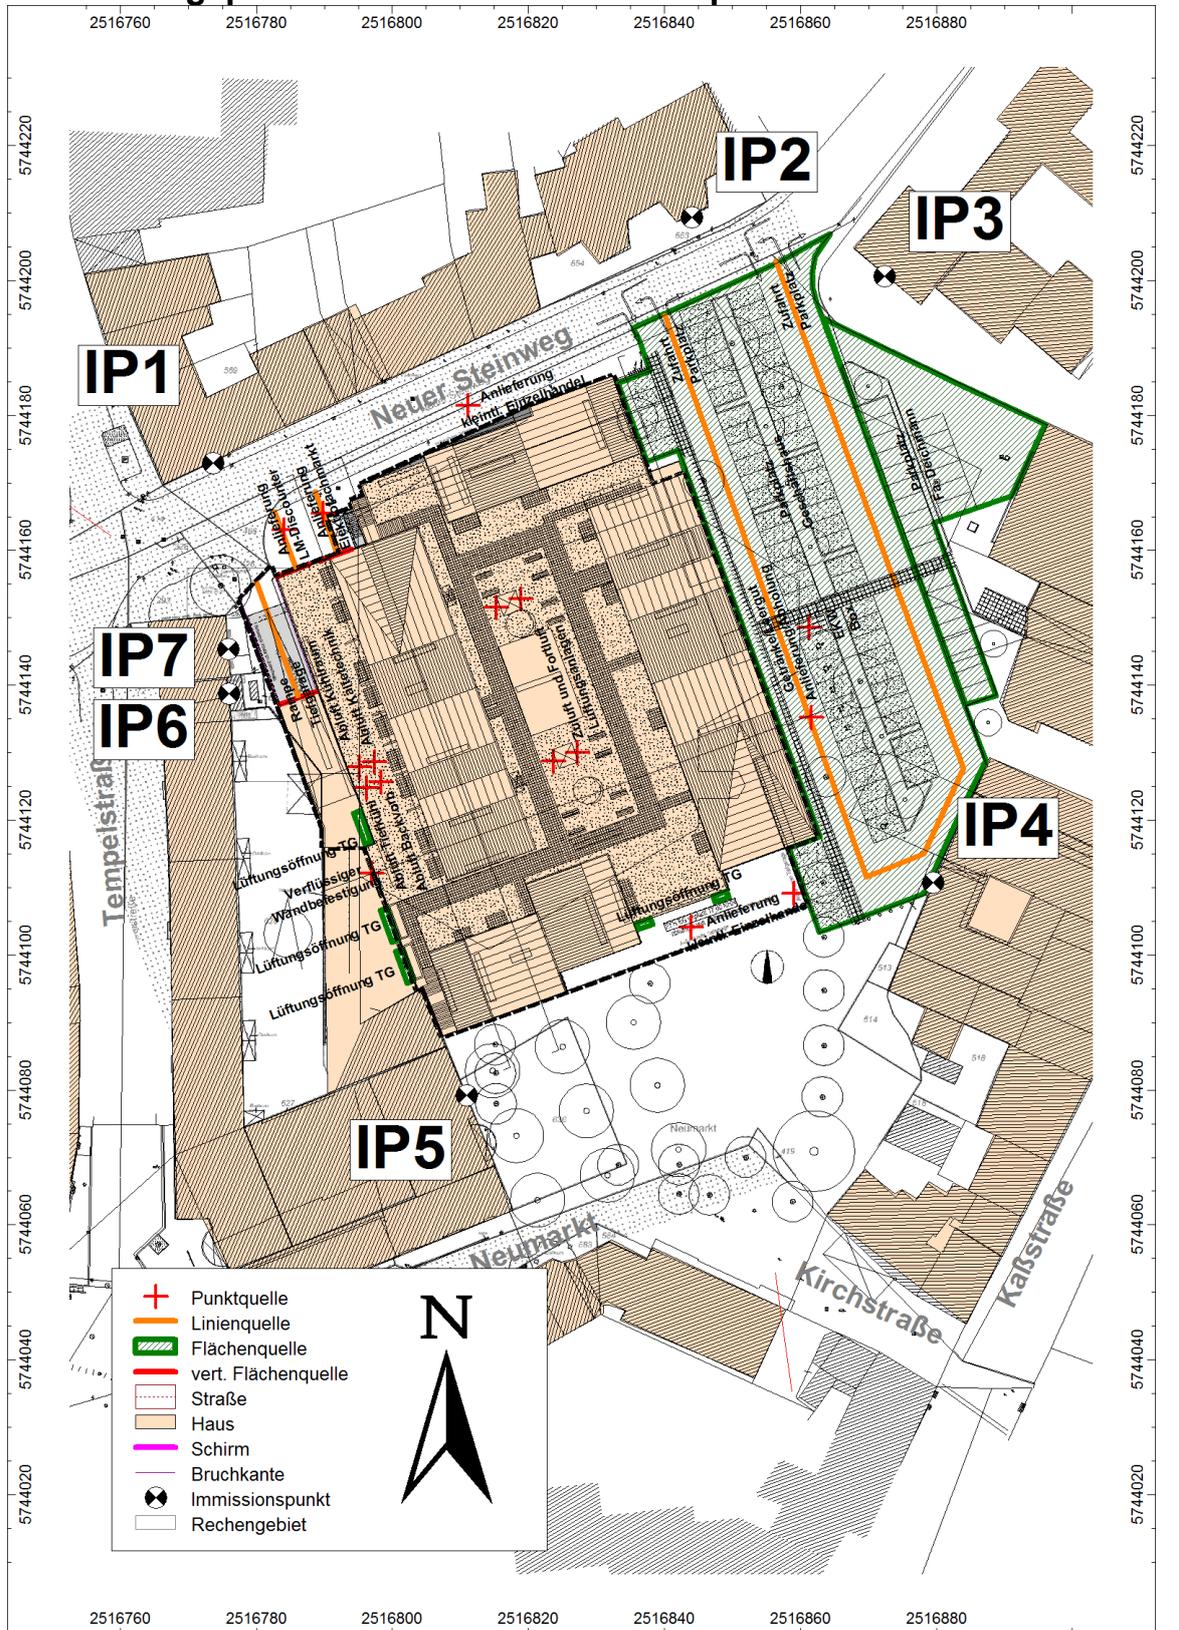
Lageplan Quellen und Immissionspunkte - Gesamtlärm
